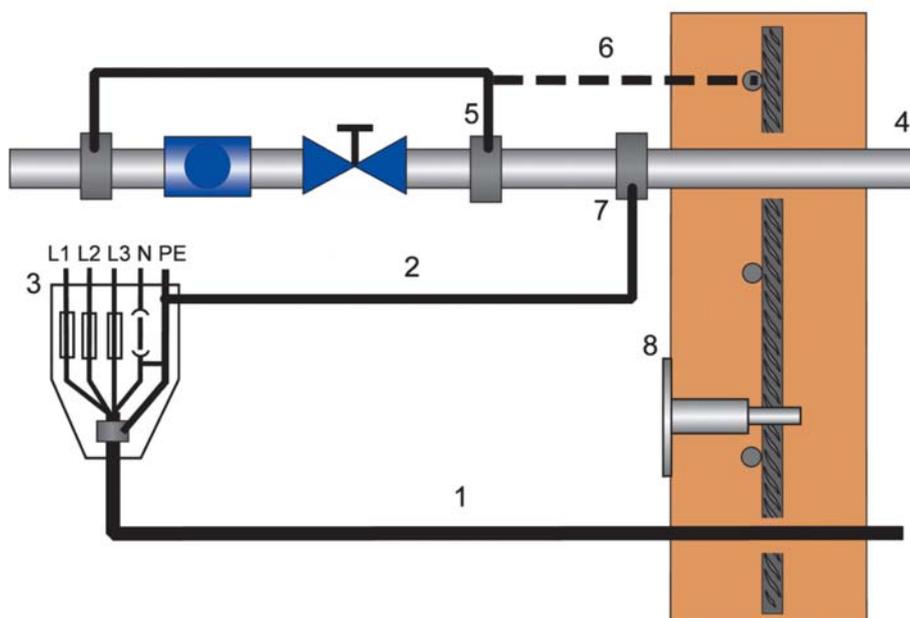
Erstellen eines alternativen Erders 8 (z. B. Fundamenterder).
